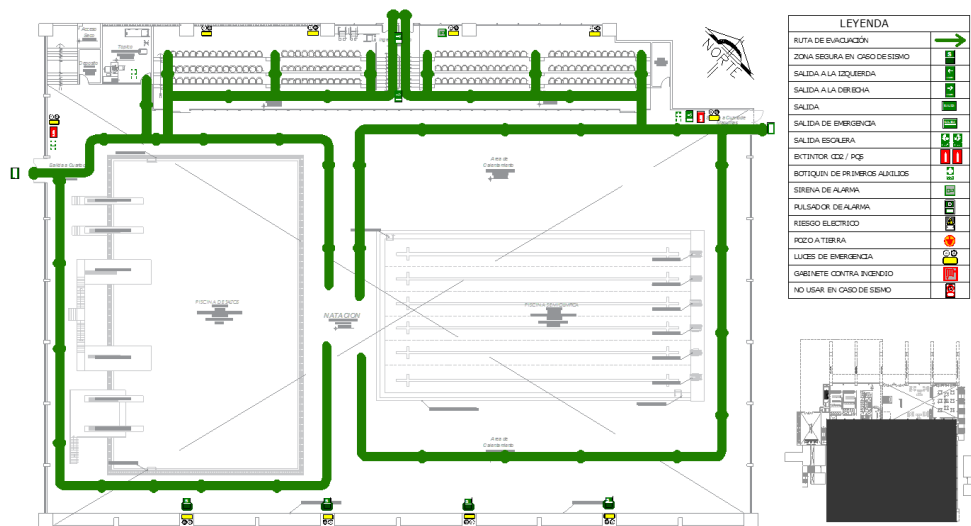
Centro de Masificación Deportiva – Planta 1/ Sector A
